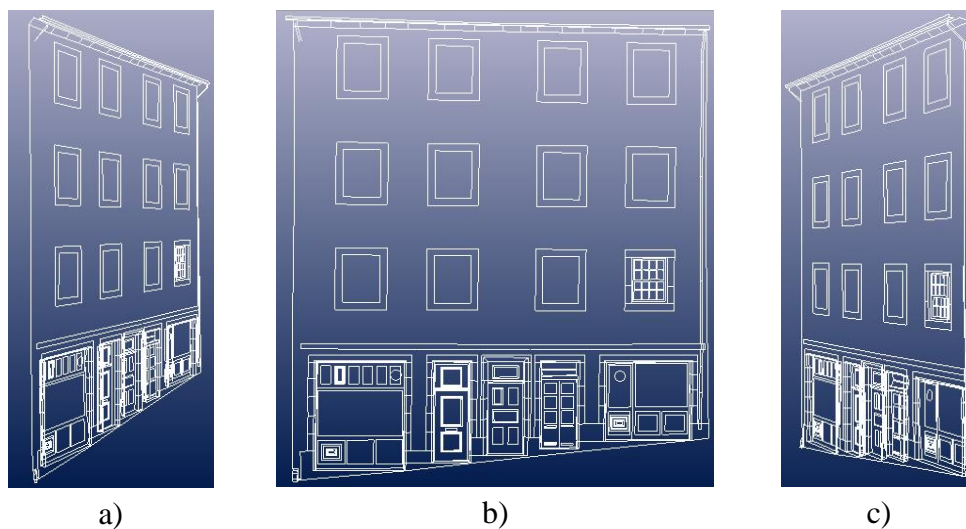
Modelo da fachada em estrutura de arame: a) vista em perspectiva do lado esquerdo, b) vista em alçado e c) vista em perspectiva do lado direito
